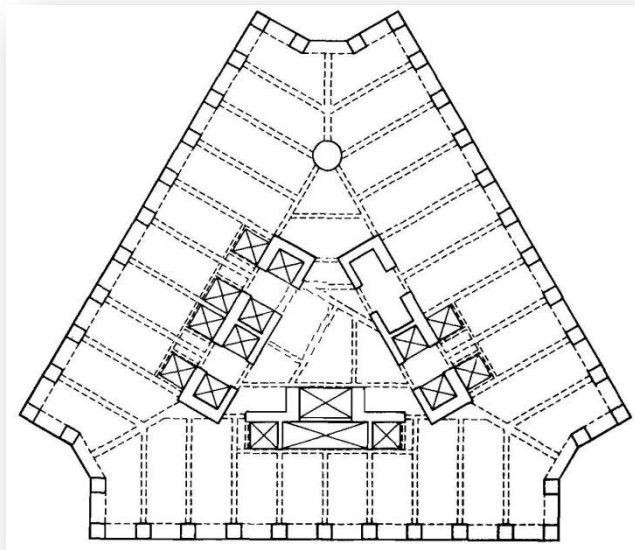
Planta tipo del piso 26, se puede ver la disminución de muros en el núcleo así como el cambio al marco de columnas cuadradas.
